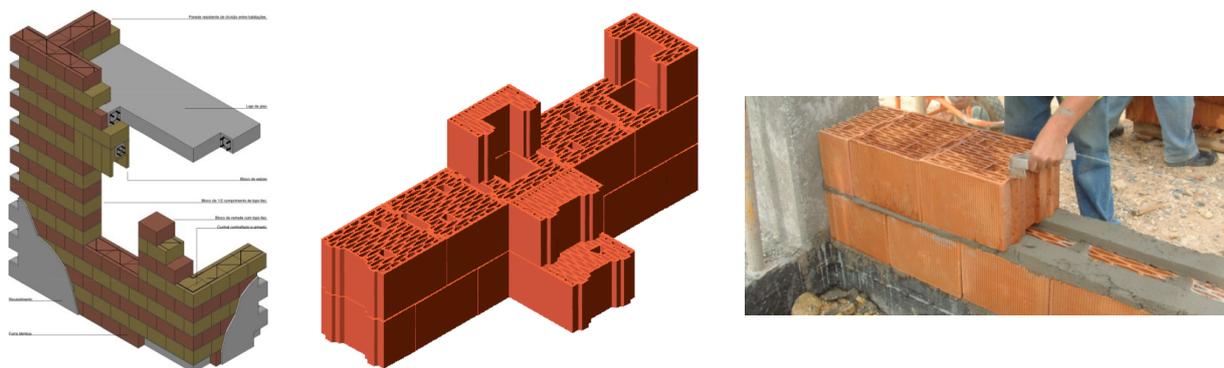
cBloco – Tijolos cerâmicos de alvenaria
